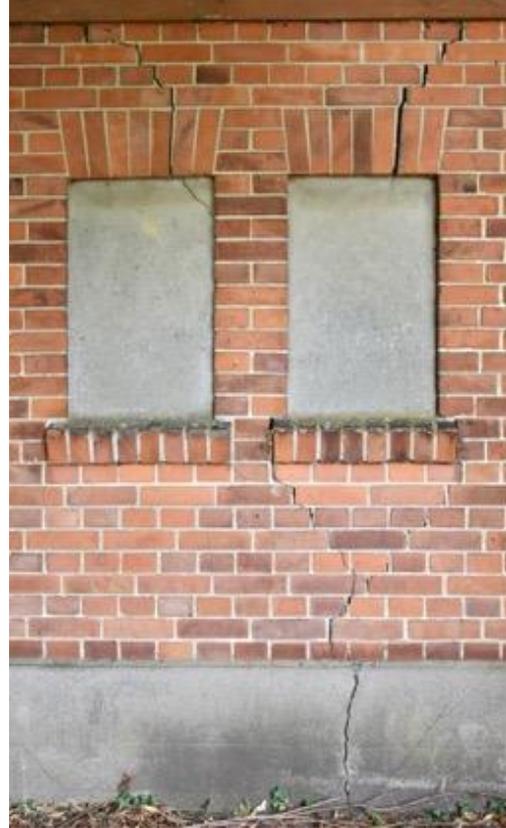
Fassadenrisse durch hochdrückende Baumwurzeln
